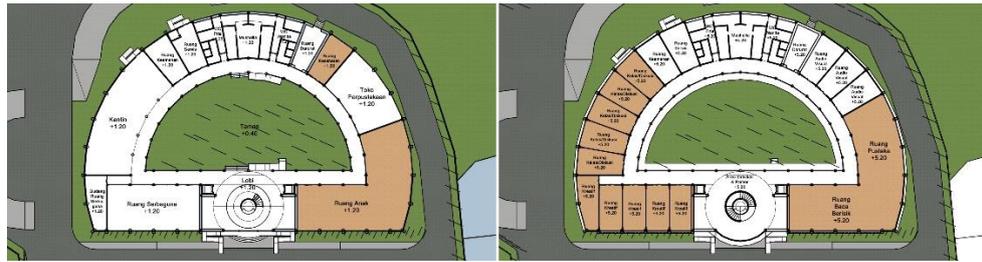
Pembagian ruang berdasarkan lantai pada bangunan.
